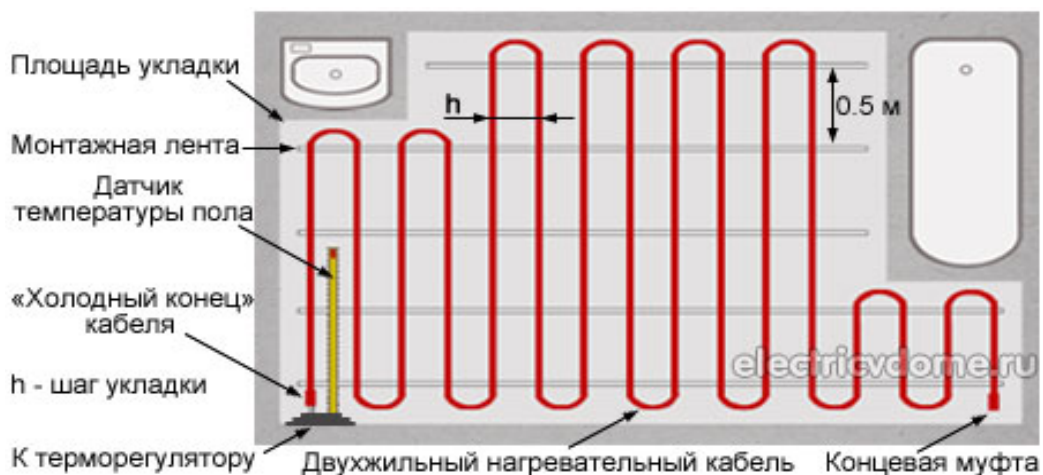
План укладки двухжильного нагревательного кабеля
